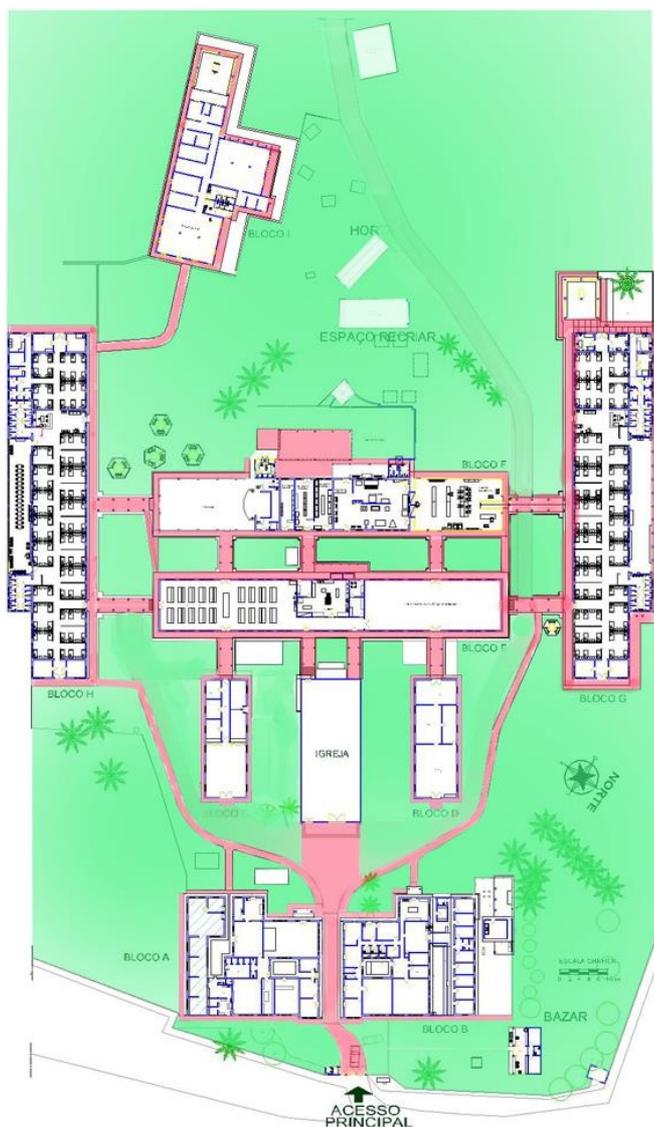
Planta baixa da ILPI, identificando áreas verdes
